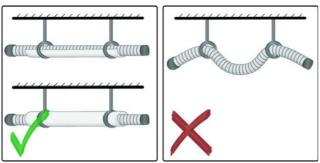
Utiliser des rails de guidage ou des coques porteuses
